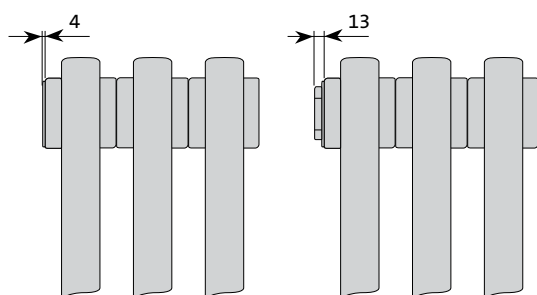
Längenzuschläge für geschweißte Deckel (links) und Stopfen; die Längenzuschläge sind für beide Seiten des Heizkörpers zu berücksichtigen
